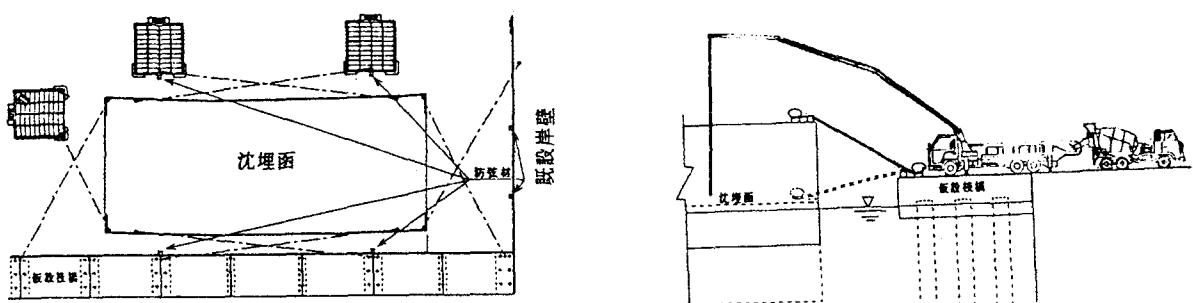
沈埋函係留状況及びコンクリート海上浮遊打設状況概要図
